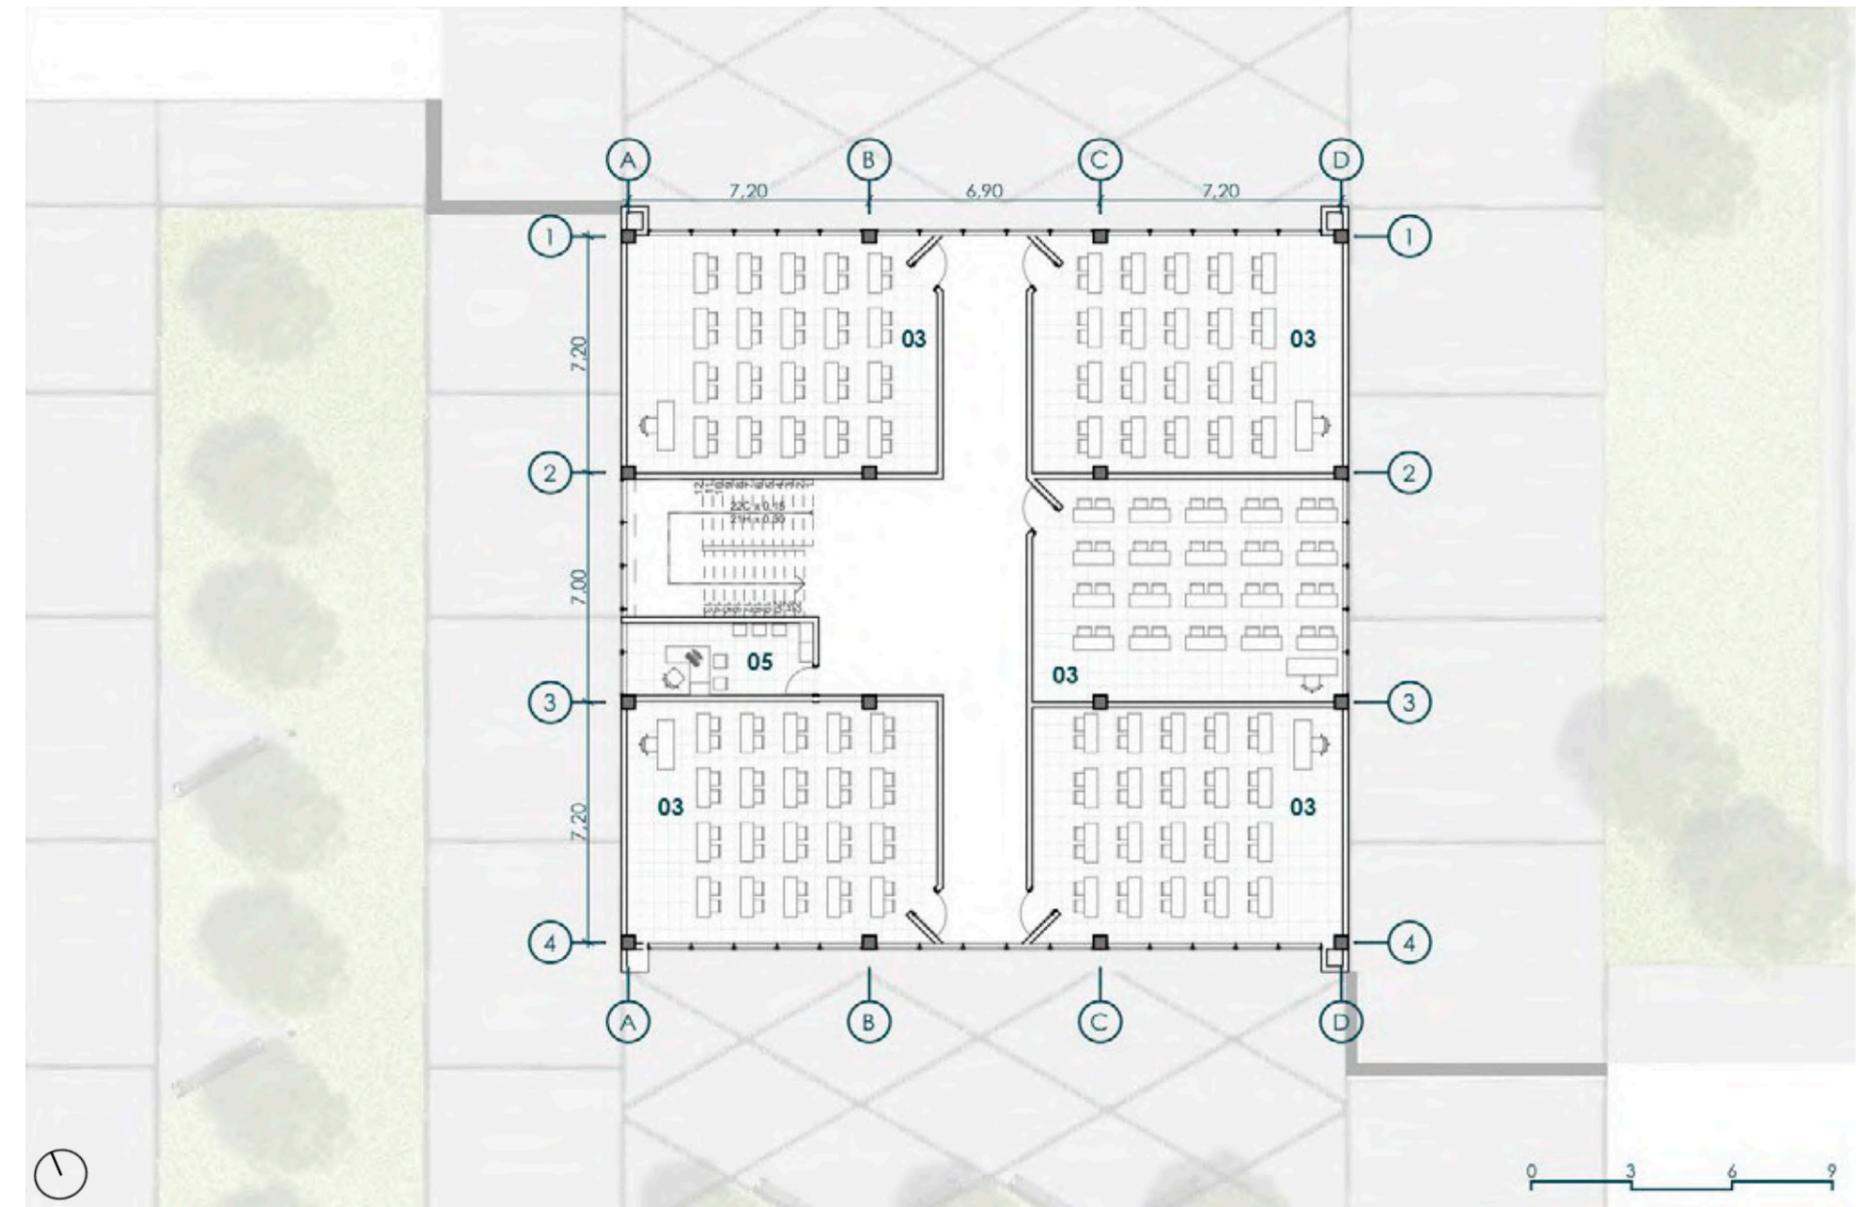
| Planta alta talleres | Fuente: Elaboración Propia
